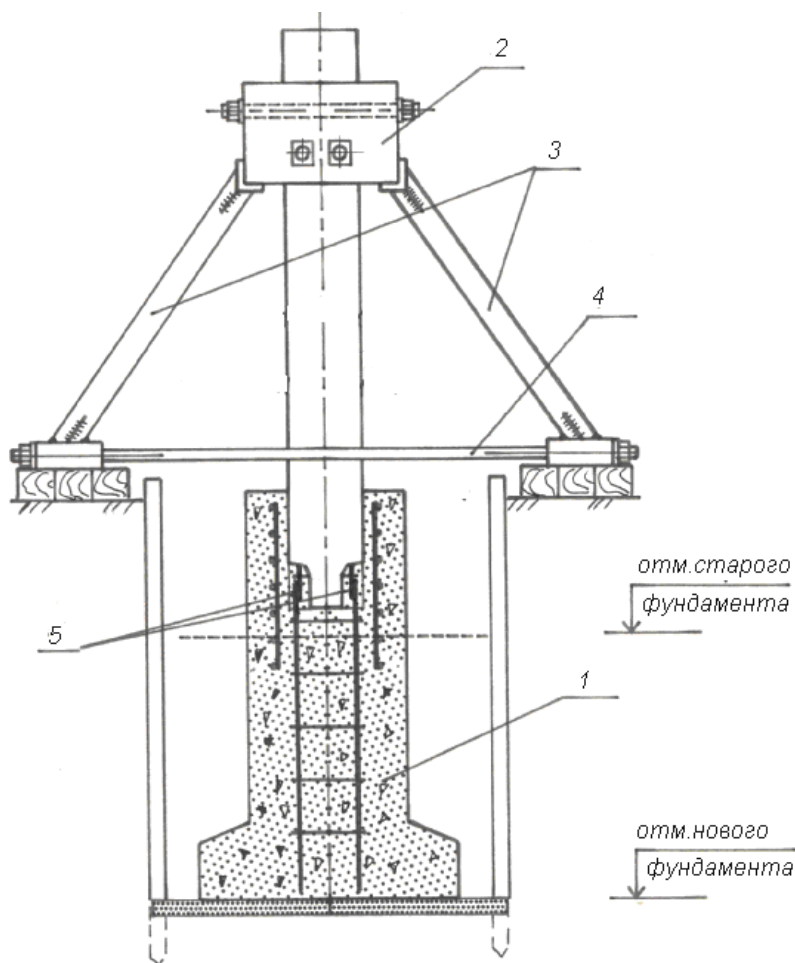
Заглубление фундамента под колонну: 1 – монолитный фундамент, 2 – опорный хомут, 3 – подкосы, 4 – затяжка, 5 – сварные стыки арматуры
